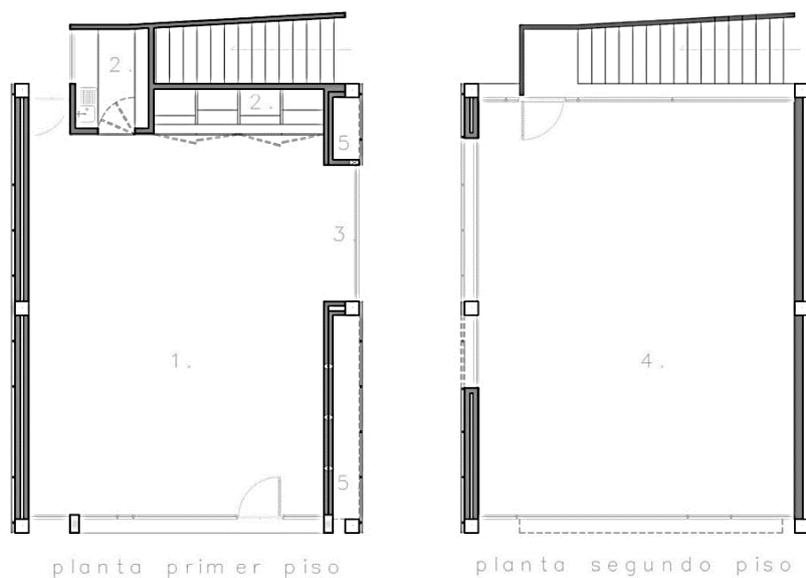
Pavimento térreo, sala multiuso - La Leroteca
